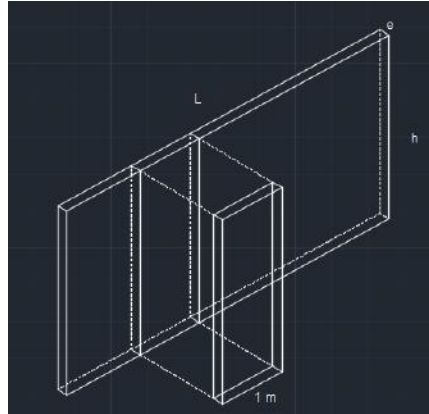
8. Esquema de vigas verticales empleadas para el cálculo del armado vertical de los muros.
